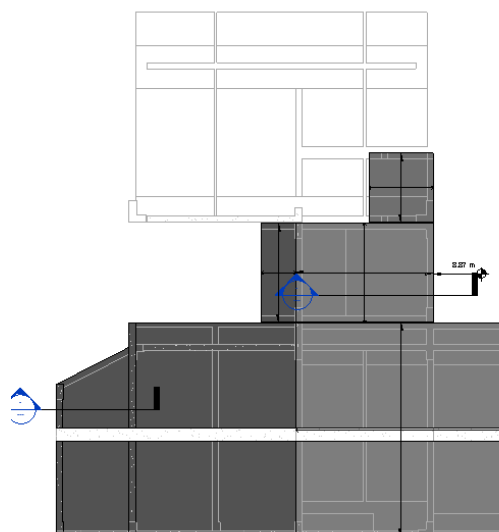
Vista en planta techo de semi sótano especialidad estructuras
